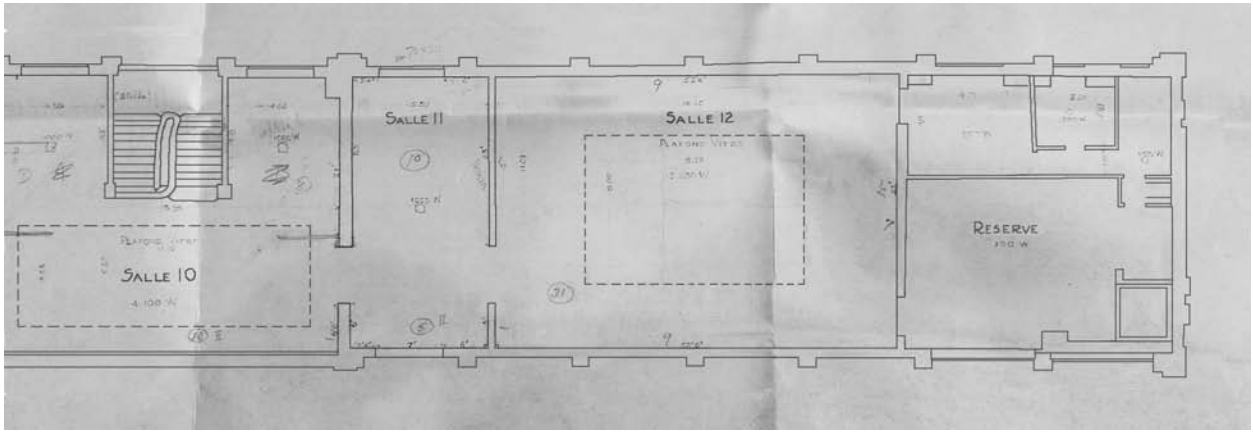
pianta del primo piano, impianto luci, 1938. Lato Concorde e corpo centrale.
